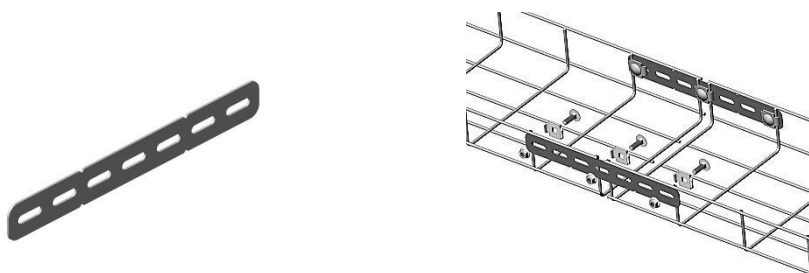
Соединитель проволочного лотка перфорированный ПжТехКабель
